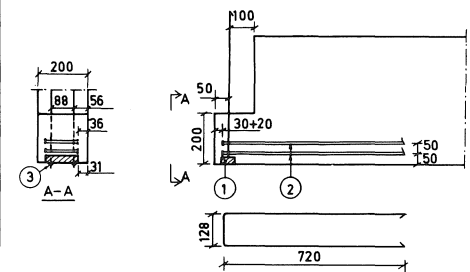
Armering i balkände. Balk VI. 1) Ankringsplatta 138x50x30 mm. 2) Dragarmering bestående av 2+2 öppna byglar Ø 8 Ks 60 S 3) Kälsvets.
